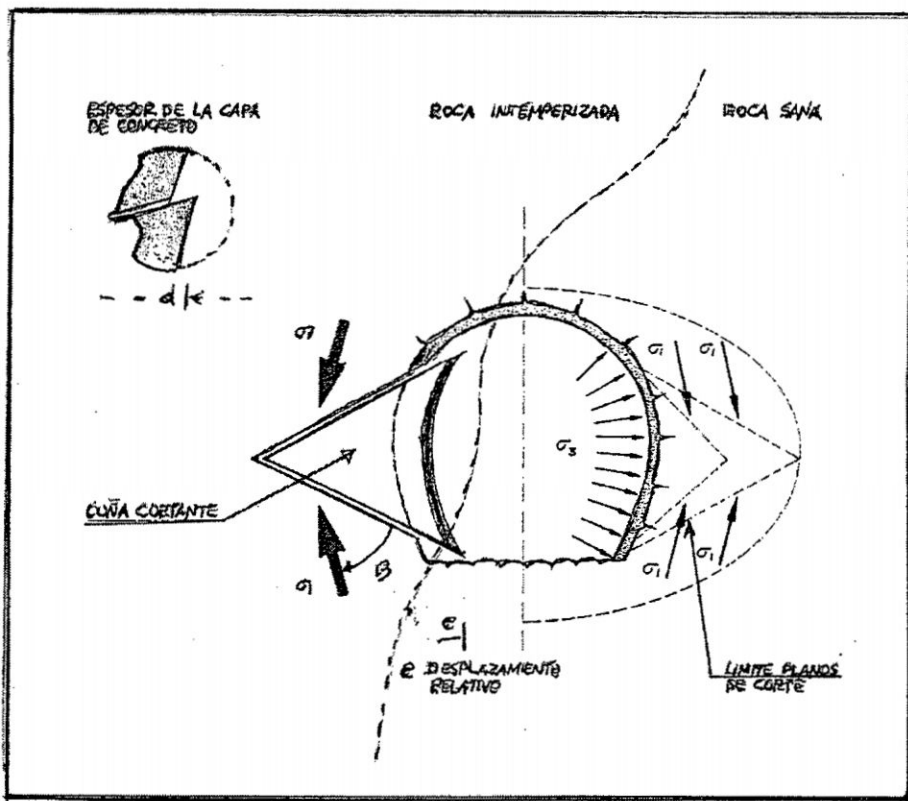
Fallamiento de pared de túnel sostenido por shotcrete
